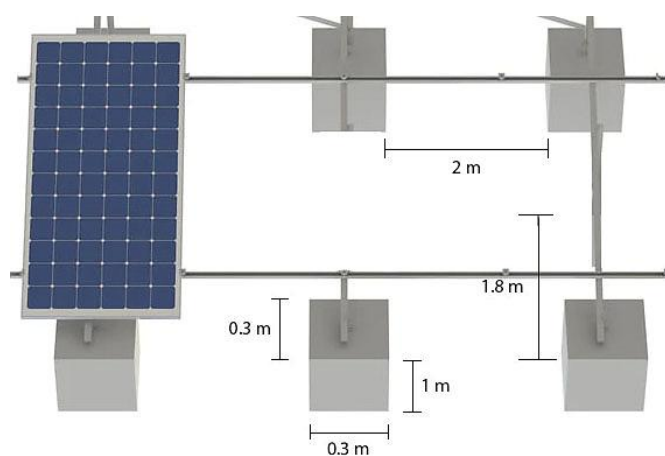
Detalles de estructura de soporte para conjunto de los paneles
